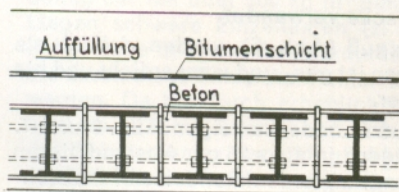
u. 9: Schutzraumdecke aus Stahl für sehr hohe Beanspruchungen.
